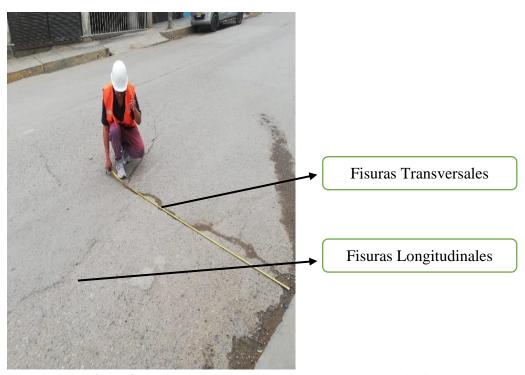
Se visualiza las fallas fisuras transversales y longitudinales
